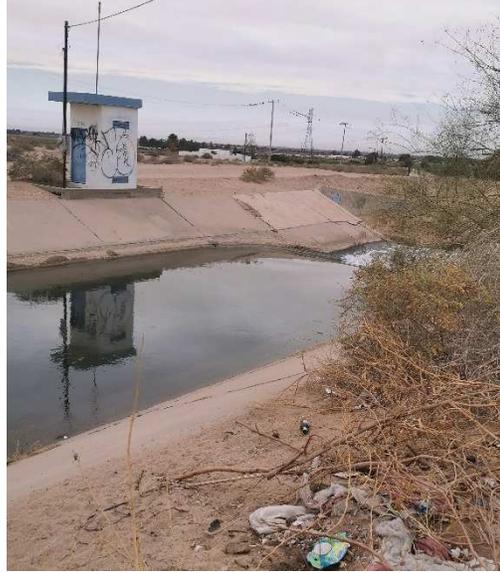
Vista hacia aguas abajo de la Caída 1 (KM 2+525) del canal y donde se construiría la represa e inicia la tubería a presión
